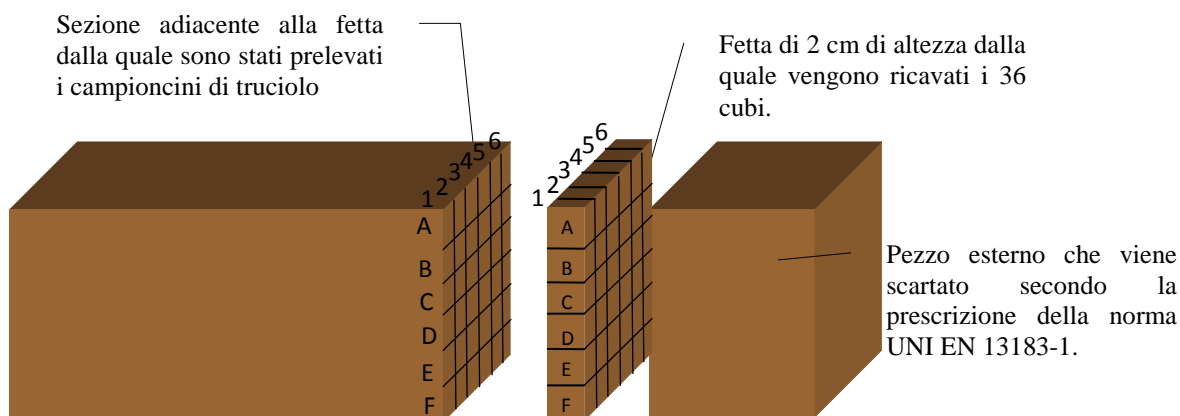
Particolare della fetta estratta dal travetto e della sezione dalla quale si ricavano i campioni di truciolo in matrice.
